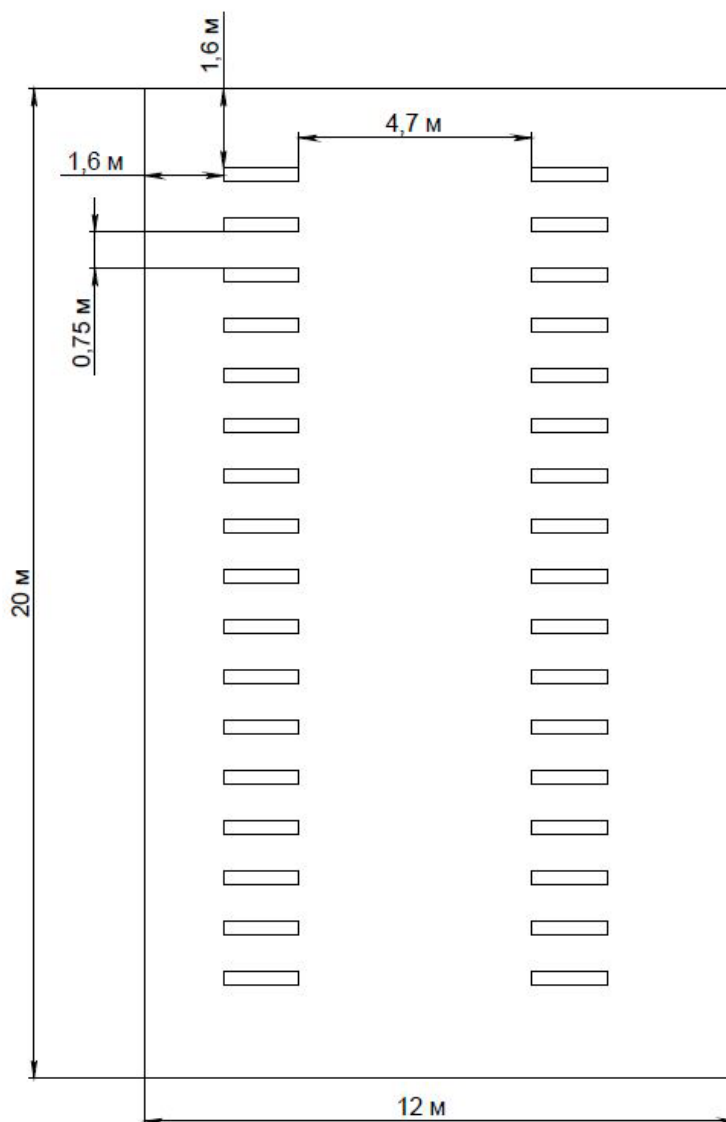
План размещения осветительных приборов в помещении токарной и гидроабразивной обработки
